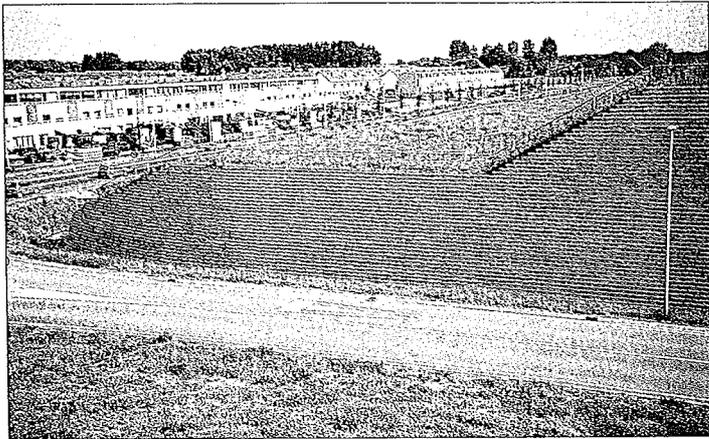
Bewehrter Schallschutzwall mit Allan-Block-Formsteinen als Deponieraum für Aschen in den Niederlanden
